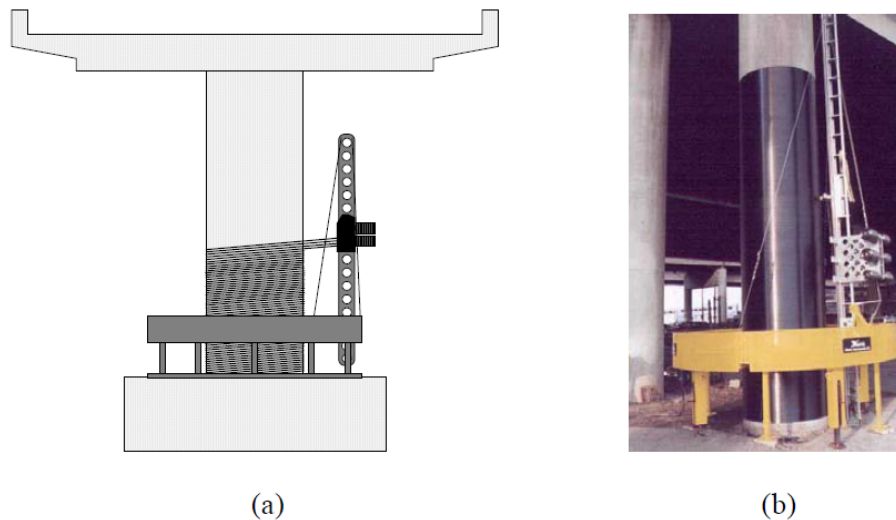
a) esquema de refuerzo de bobinado automático, b) Robot de bobinado automático¹.
